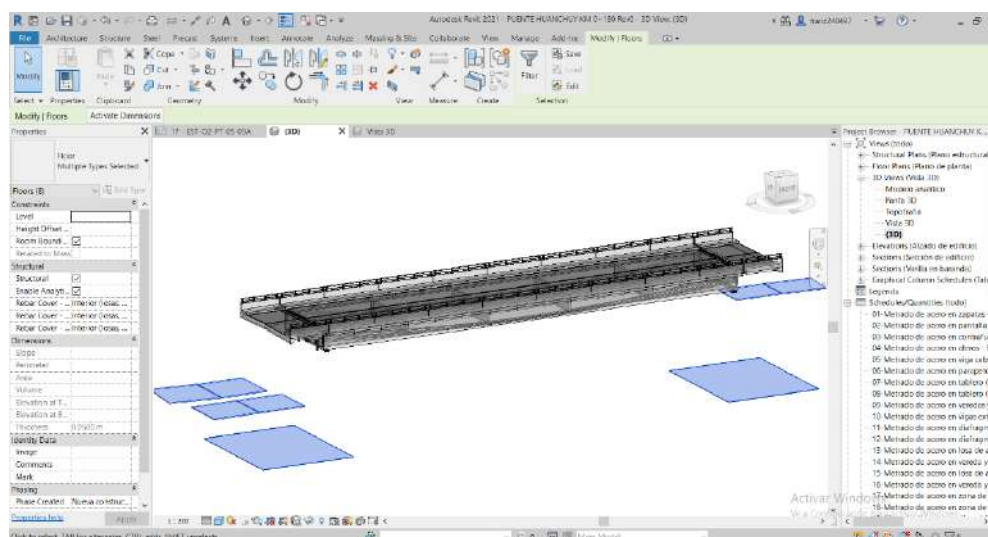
Vista del componente “Floor/Suelo” de Estructuras.
